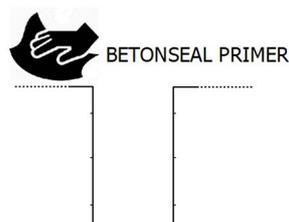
applicazione di BETONSEAL PRIMER alla bocchetta
